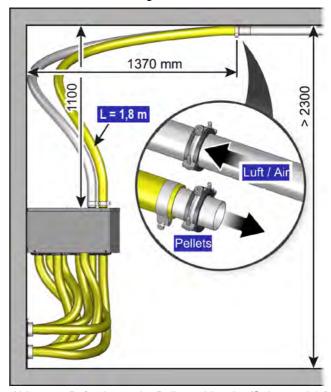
Befestigung der Pelletsschläuche (Seitenansicht)
